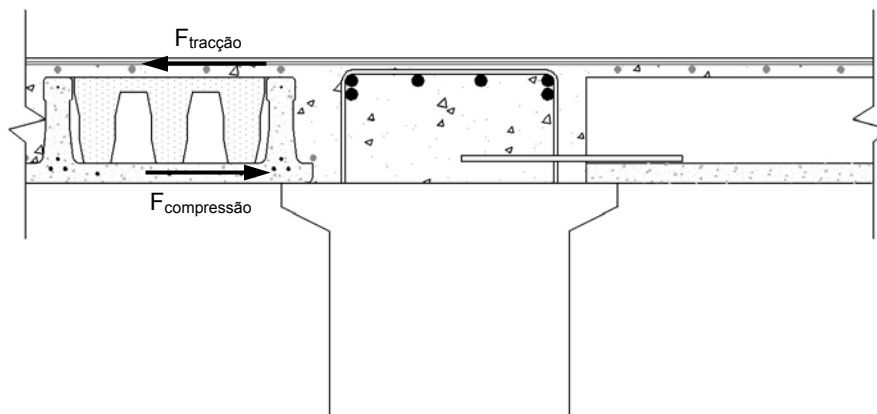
Forças de tracção e compressão junto ao apoio da laje na viga
